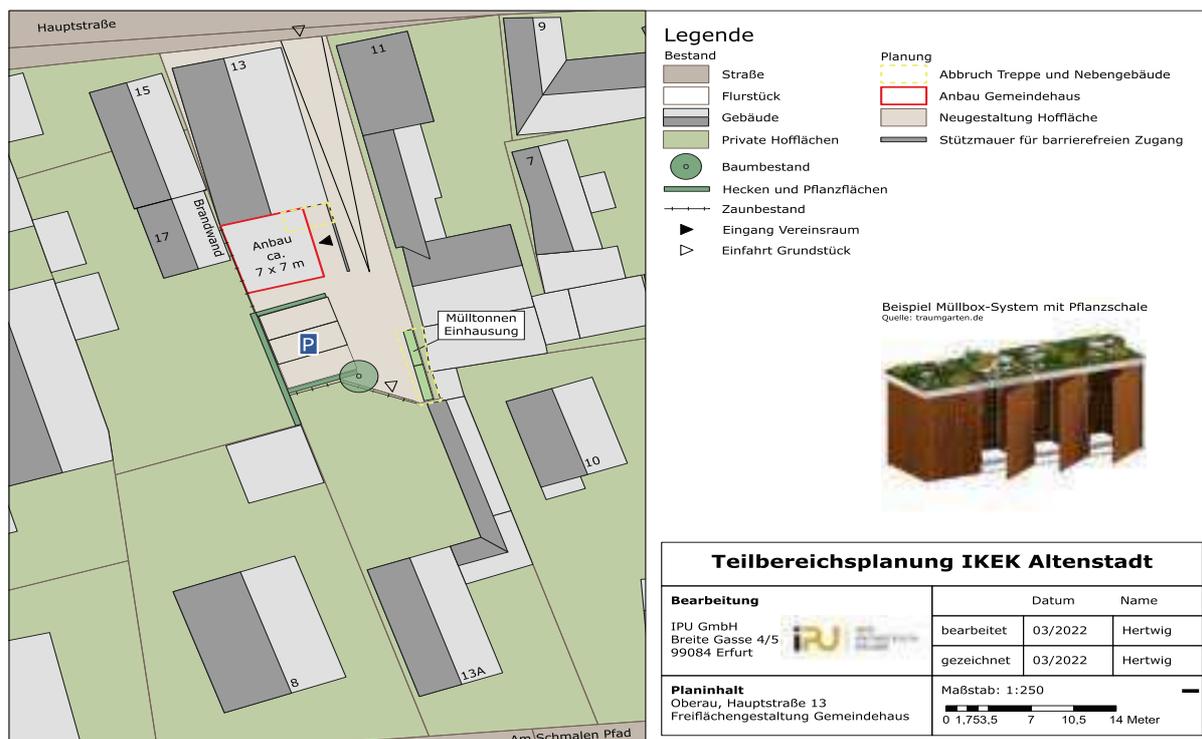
Planungsskizze Außenbereich Gemeindehauses Oberau (Variante 1), Quelle: Eigene Darstellung
